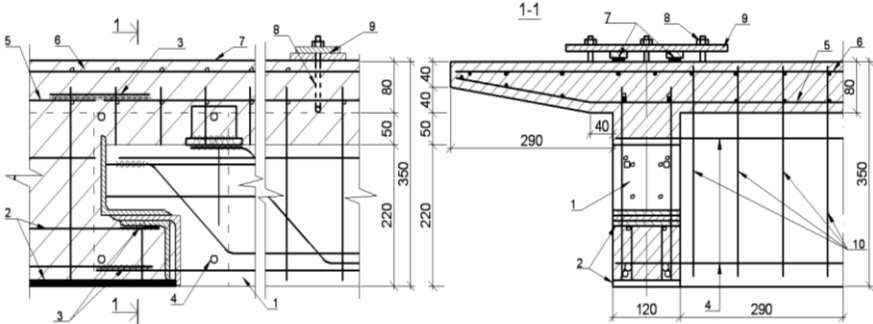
Стик збірних і монолітних балок: 1 – збірна балка; 2 – закладна деталь монолітної надопорної балки із листовою арматурою стисненої зони; 3 – зварний стик випусків поздовжньо арматури збірної балки і закладної деталі монолітної ділянки; 4 – арматура діафрагми; 5 – нижня сітка плити; 6 – верхня сітка плити; 7 — неметалева стрічкова арматура Sika CarboDur S212; 8 – закладні болти для анкерування кінців стрічок; 9 – деталь для кріплення кінців стрічки Sika CarboDur S212; 10 - хомути діафрагми
